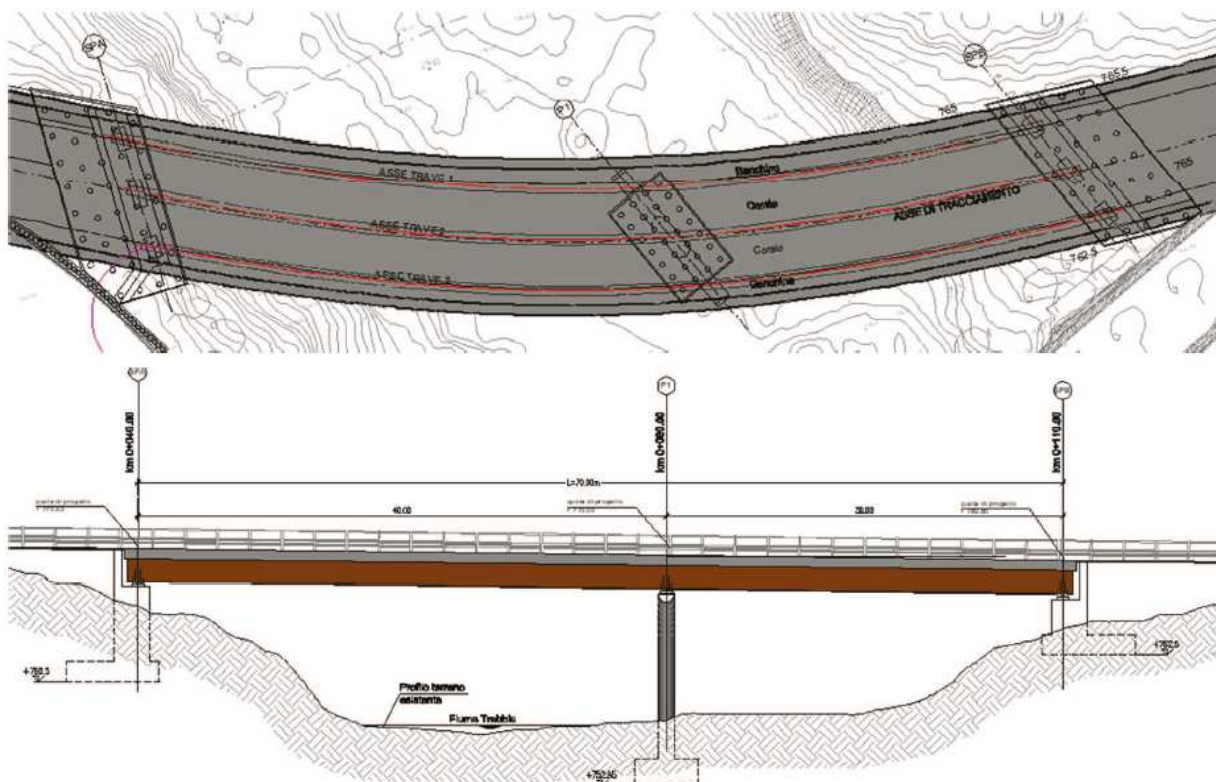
Viadotto VI05 (Ponte sul Trebbia) – Planimetria e prospetto
